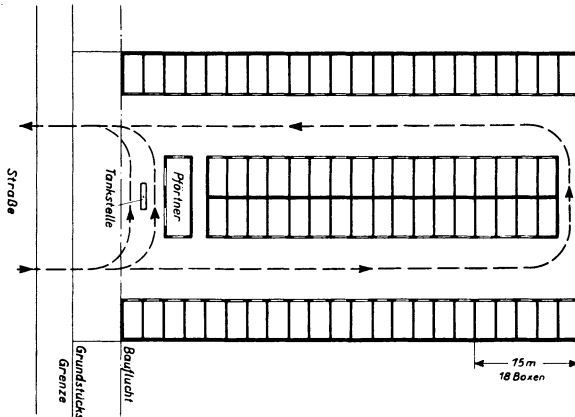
Grundriß einer Flachgarage unter Vermeidung von Eckbauten.
